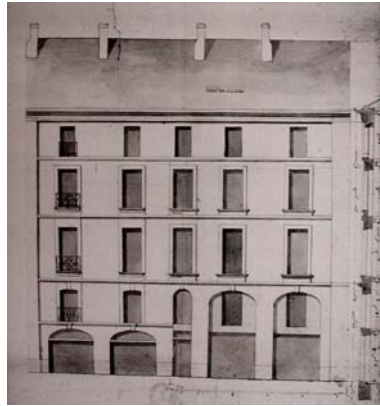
Façade rue St Clément établie par l'architecte Marmayou en 1779 et extrait d'un module de façade et son profil
